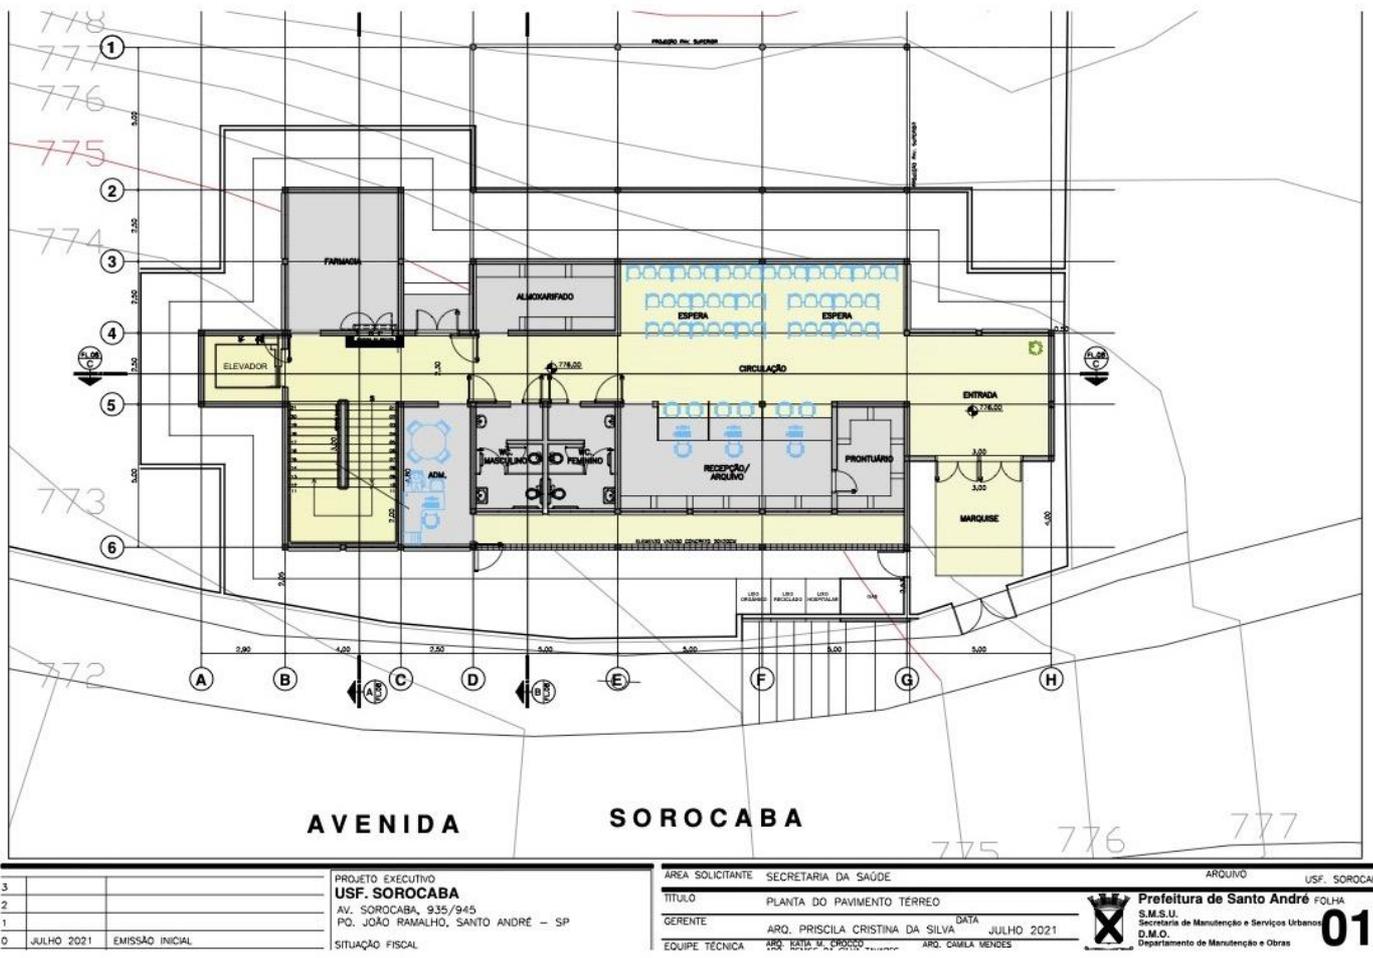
USF Sorocaba. Planta do pavimento térreo.
